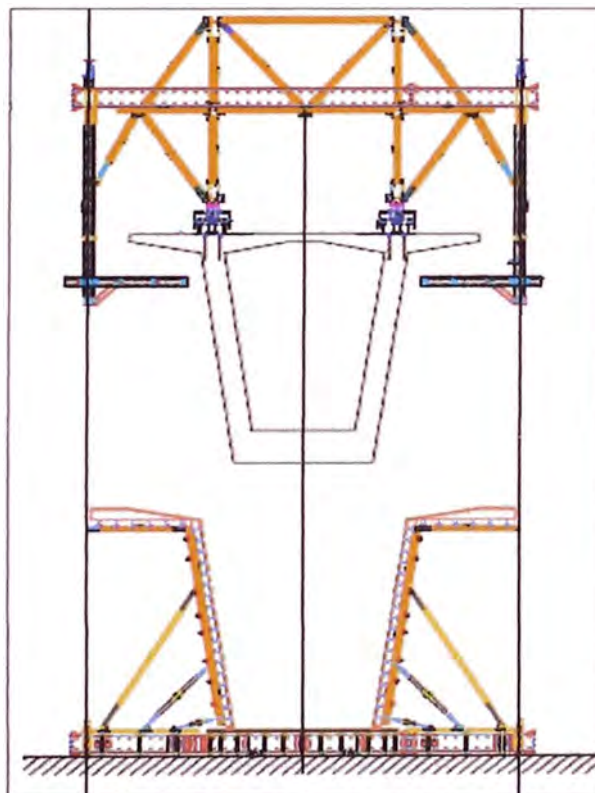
Vista izado de encofrado exterior y encofrado de fondo.
